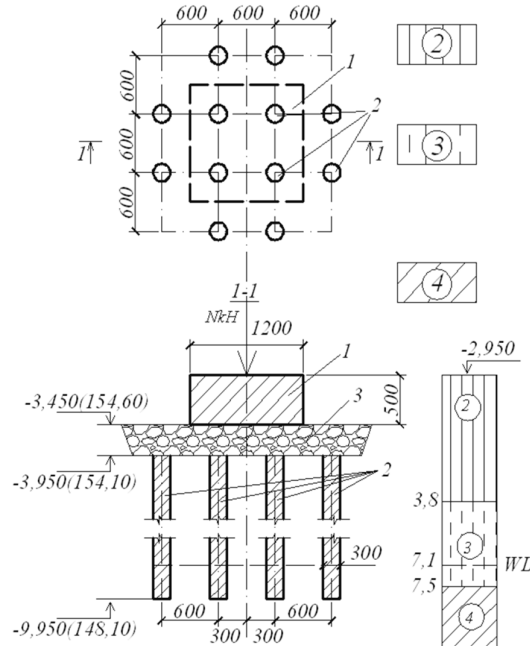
Схема випробувань основи, яка армована вертикальними ґрунтоцементними елементами, залізобетонним квадратним штампом [1]
